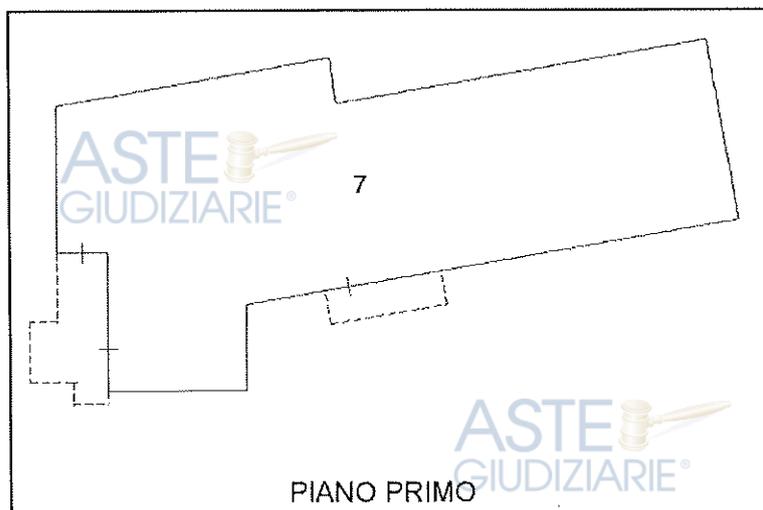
Estratto dell'elaborato planimetrico (piano primo)
